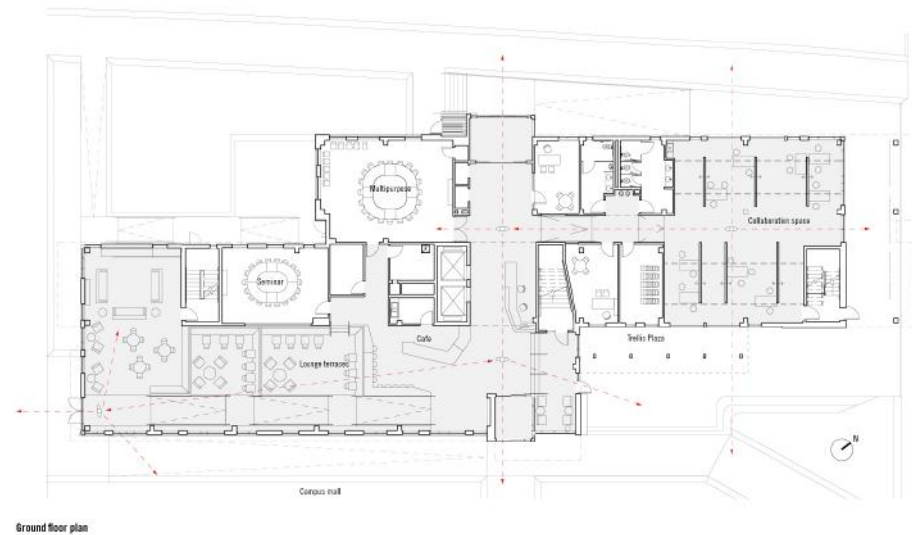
Planta Baixa Pavimento- Tipo do Edifício da Living and Learning Residence Hall 6 - Gallaudet University. Detalhe para as visadas internas / Fonte: LTL Architects
